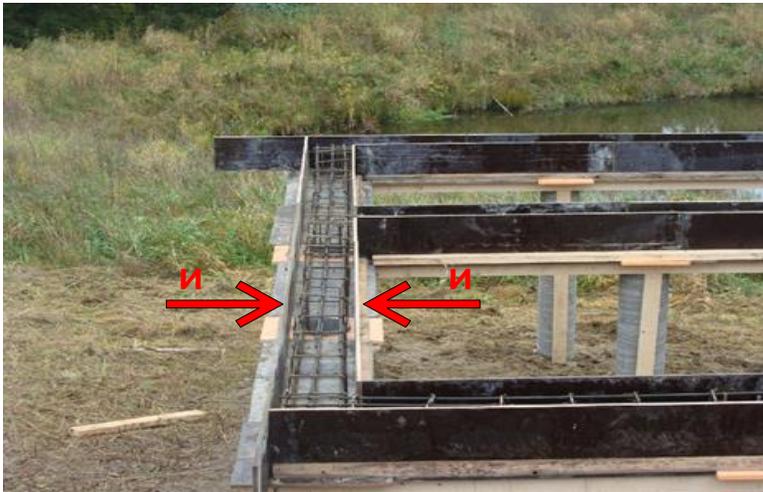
Внешний вид опалубки для изготовления горизонтальных элементов свайно-ростверкового фундамента:
